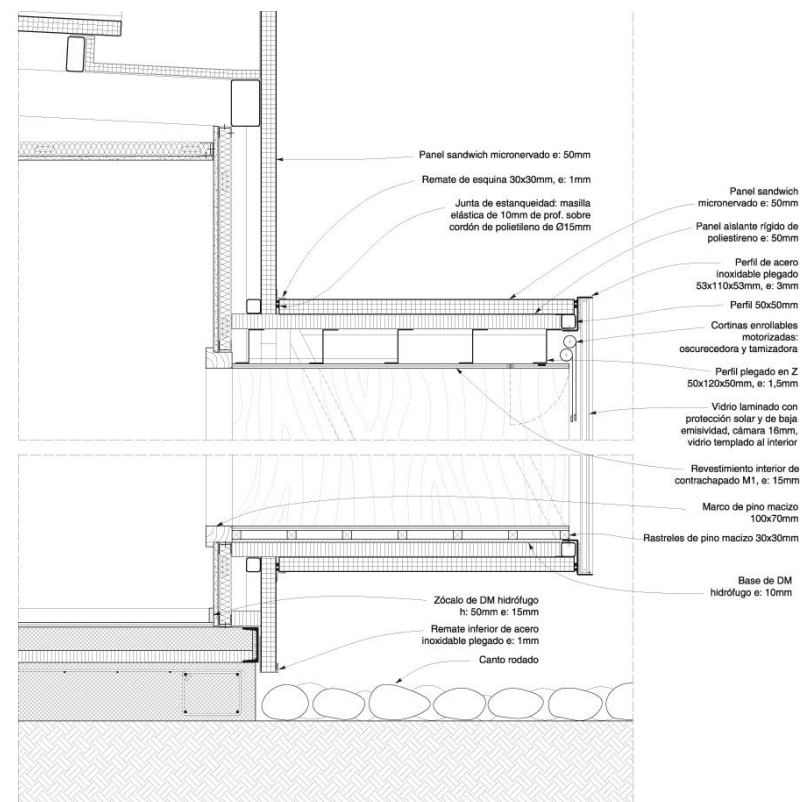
Detalle Habitación Hotel Aire de Bardenas, España.
